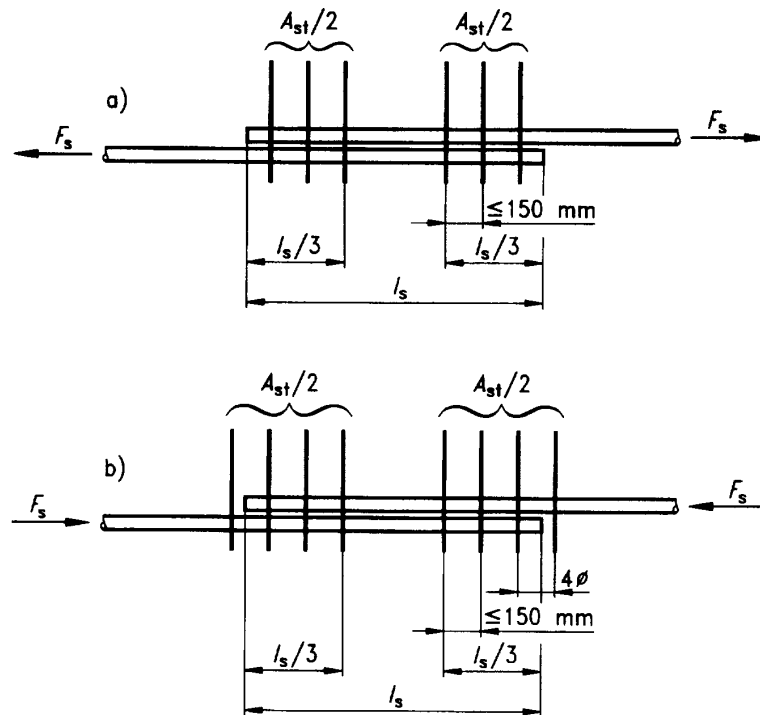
Armature trasversali in giunzioni per sovrapposizione
